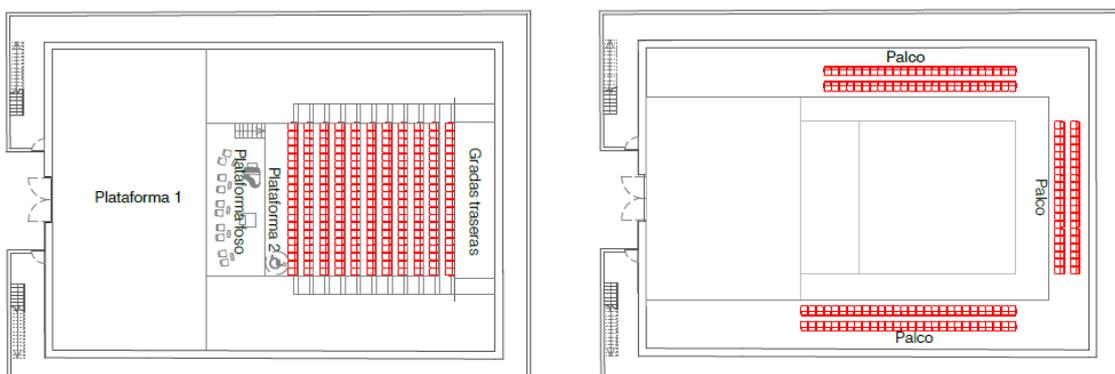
Planos de las plantas baja y alta en configuración italiana con foso. Esquema de la autora
